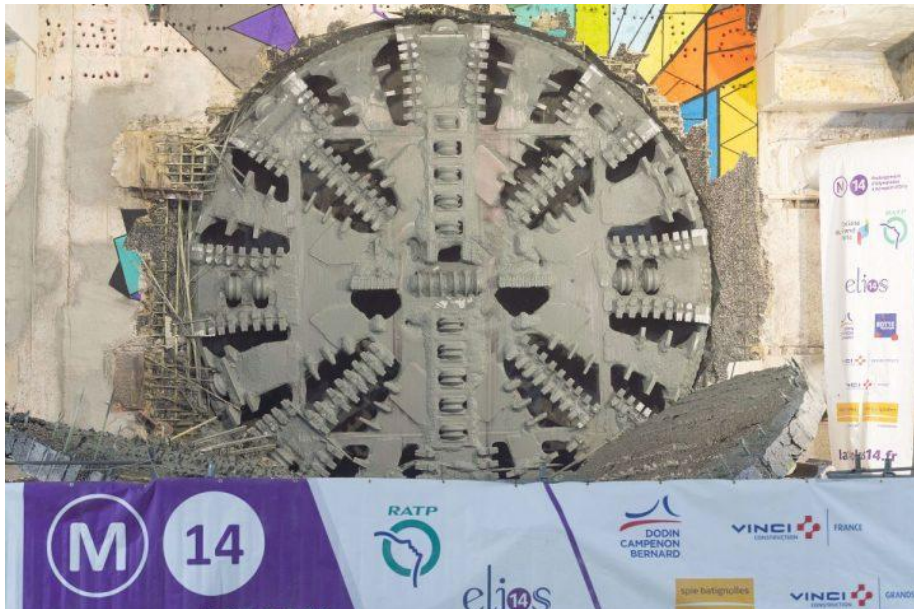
Tunnelier de dernière génération (Source: Vinci-construction)
